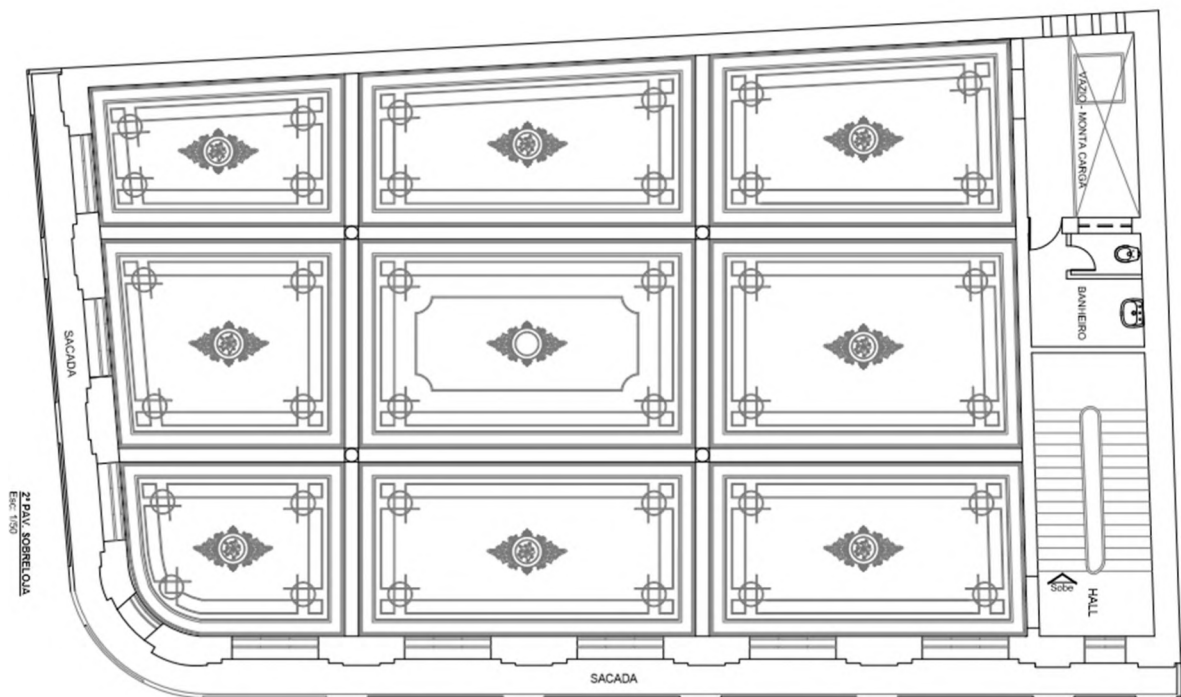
Planta do forro do 1º pavimento - sobreloja loja dividida em nove quadrantes. Fotografias do forro do 1º pavimento - sobreloja. Fonte: Arquivo M2N Arquitetura Ltda.
